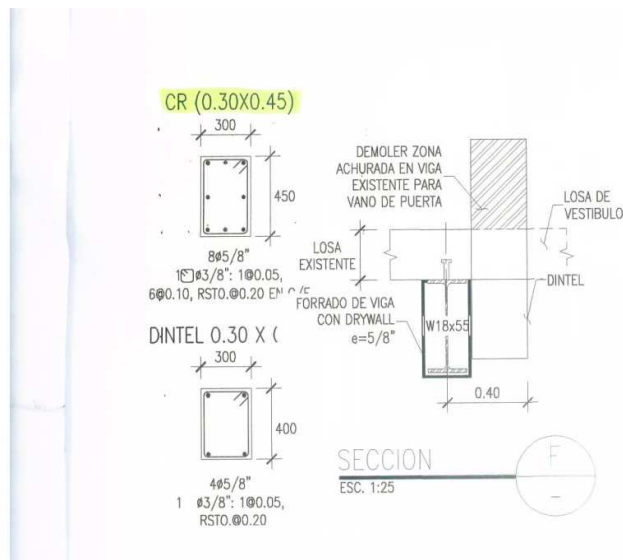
Vigas invertidas a ser demolidas. Fuente: Plano estructural del Expediente técnico del adicional N° 3
